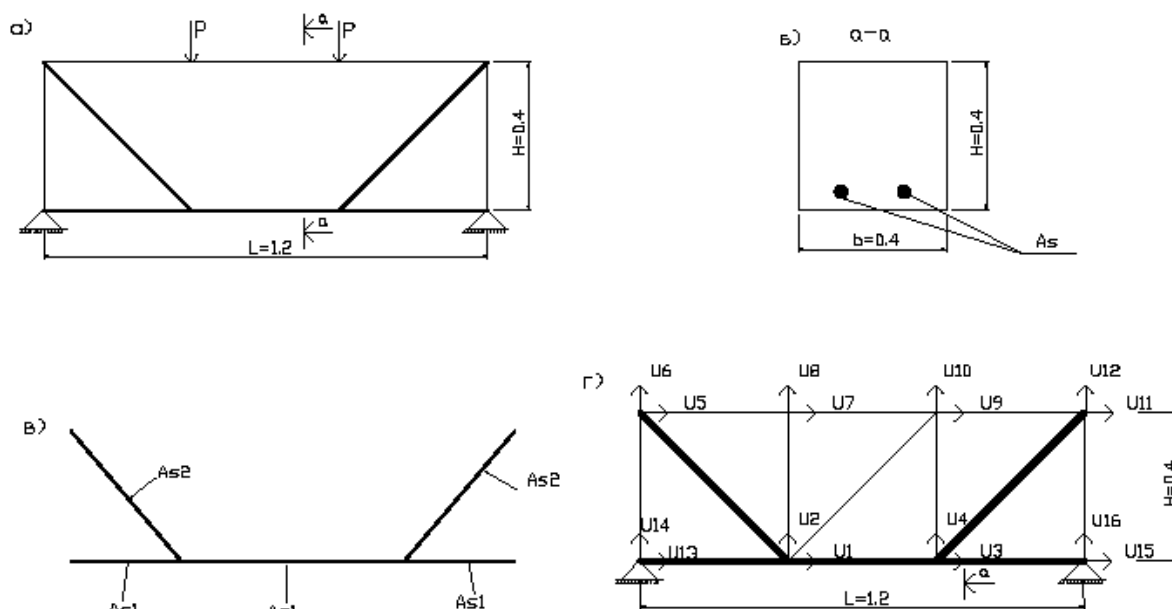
Схема железобетонной балки: а,б) Расчетные схемы балки;
